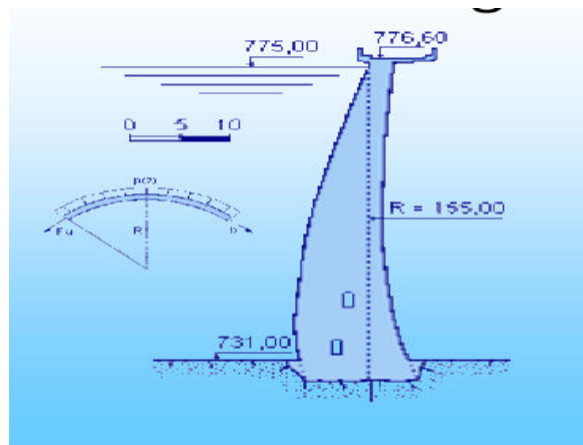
2 : coupe transversale d'un barrage voûte (Gramme 2006)
